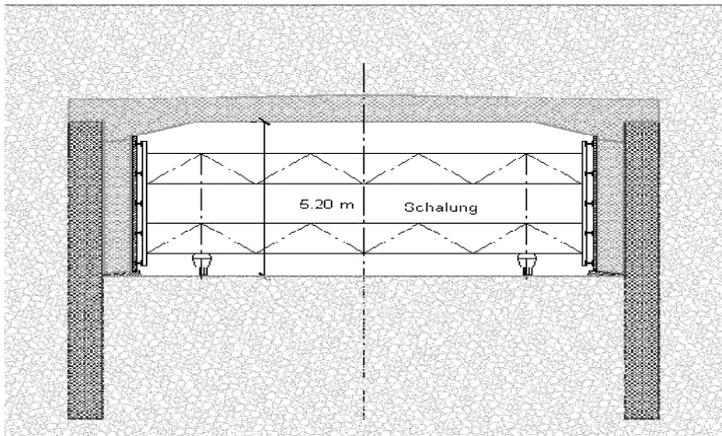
Betonieren der oberen Tunnelinnenwände
